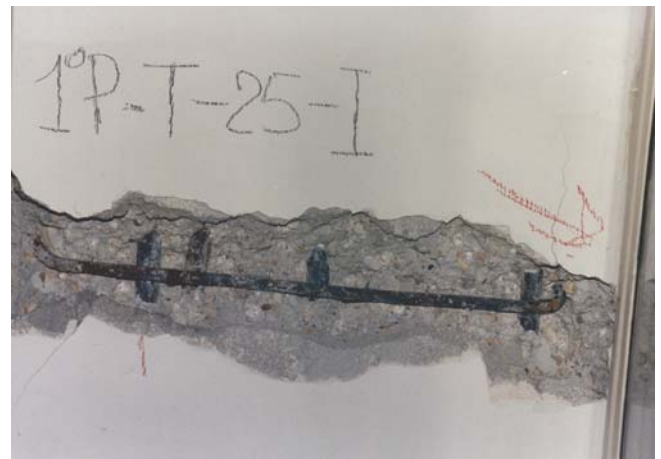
Armature di una trave vicino al pilastro
